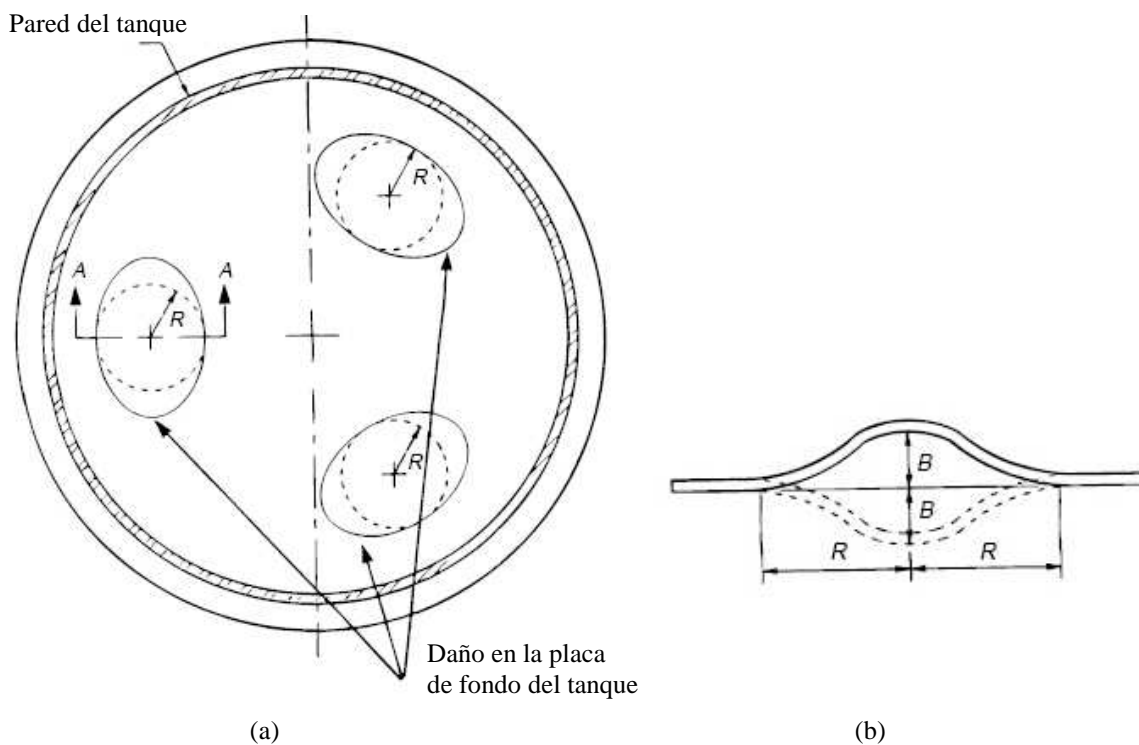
Daño localizado alejado de la pared del tanque: (a) Vista en planta, (b) Corte en sección A-A.
